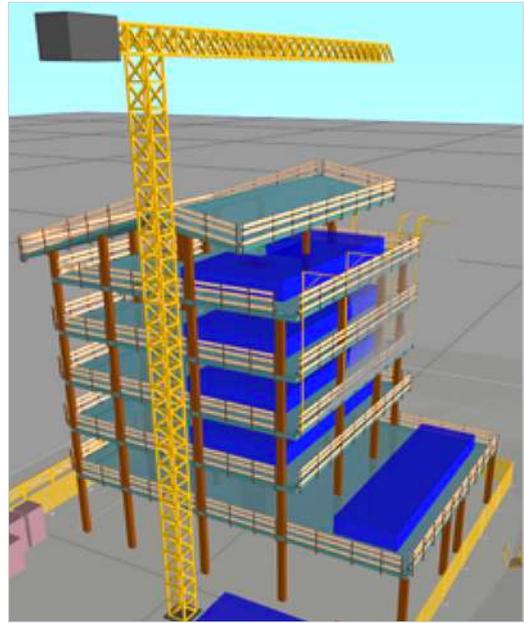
Vista 3D zonas de acopio. Manual de Instrucciones - PRL en BIM
